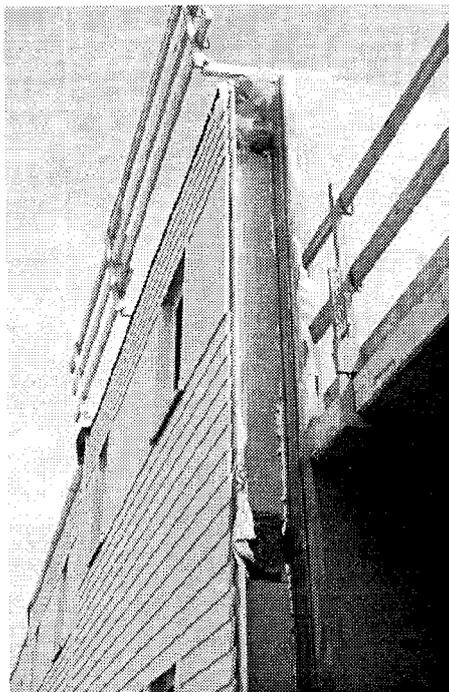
Passivhäuser Wiesbaden-Dotzheim – Montage der vorgefertigten Fassadenelemente an der inneren tragenden Struktur
